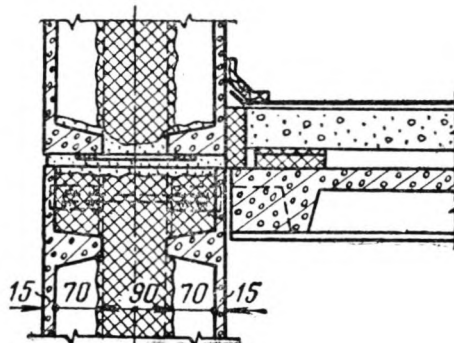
Узел сопряжения междуэтажного перекрытия и наружной стены из прокатных панелей
